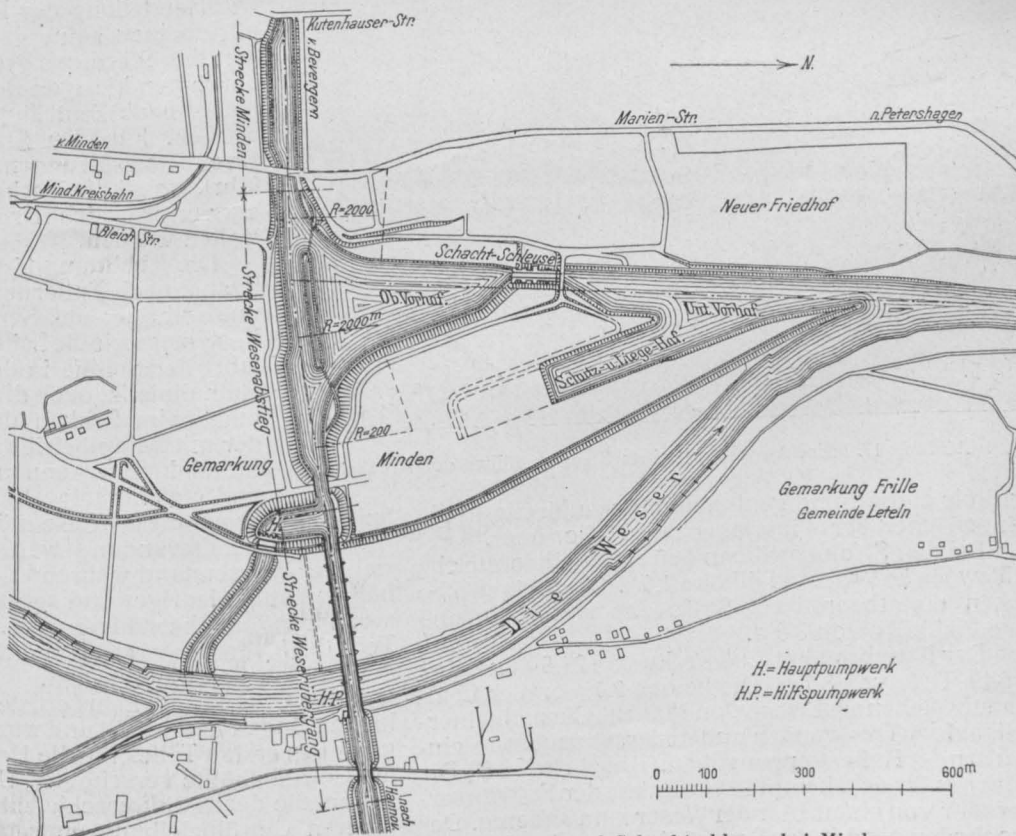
Lageplan für Brückenkanal und Schachtschleuse bei Minden.
